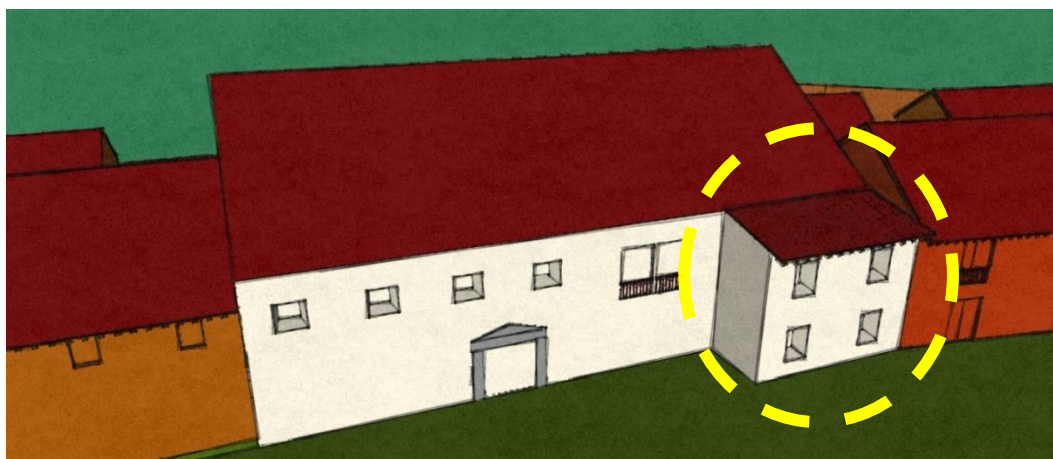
fachada del edificio de mampostería y detalle de la "torrecilla" (Silvia Arroyo). Ver anexo 5.
